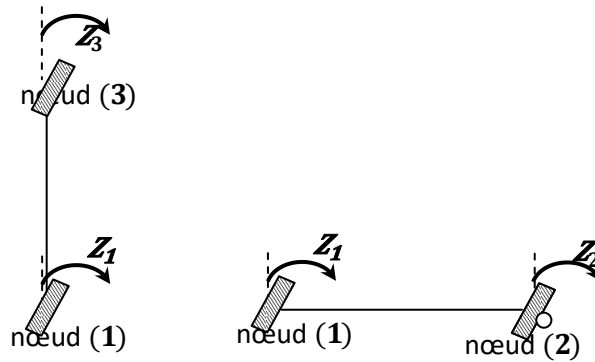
Portique de la figure 4.3. (Exemple : barre 1-2 et 1-3)
